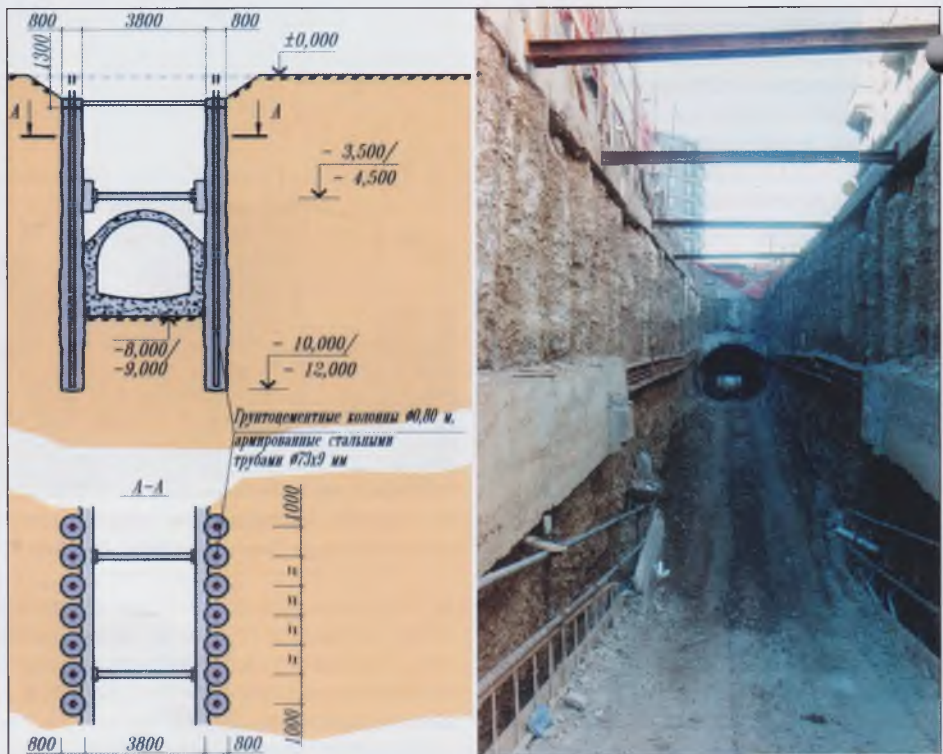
Ограждение котлована из грунтоцементных свай-колонн на строительстве коллектора открытым способом
